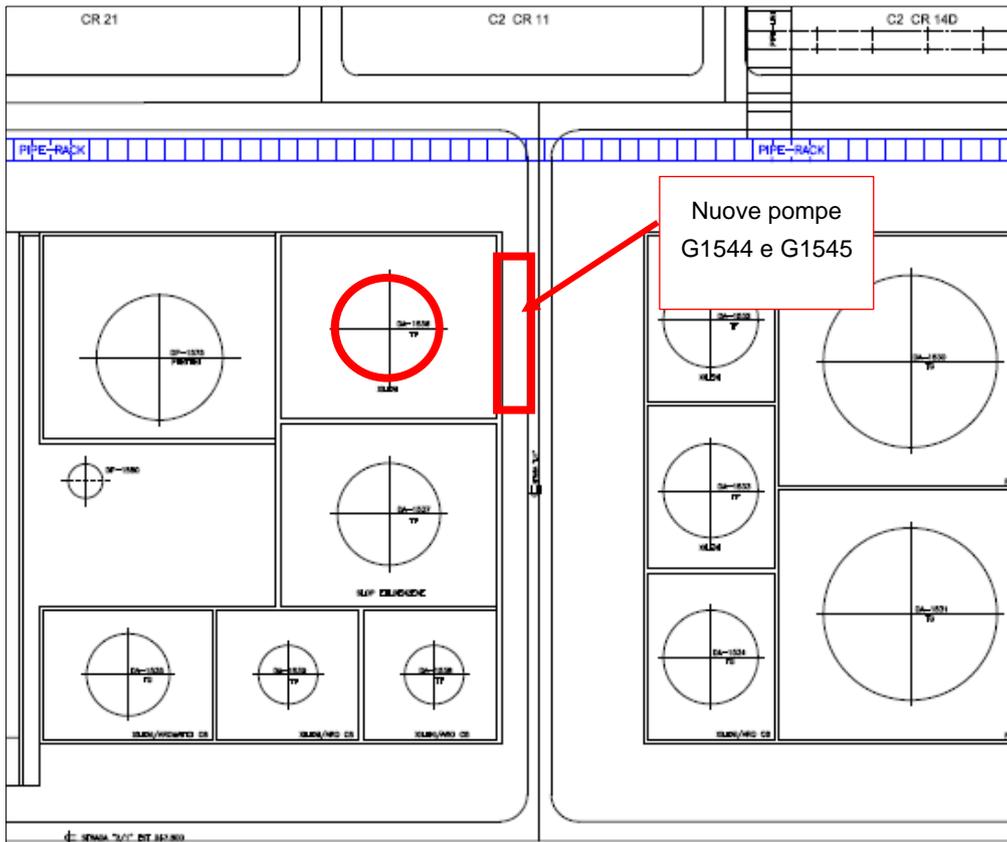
Dettaglio posizionamento planimetrico serbatoio DA1536
